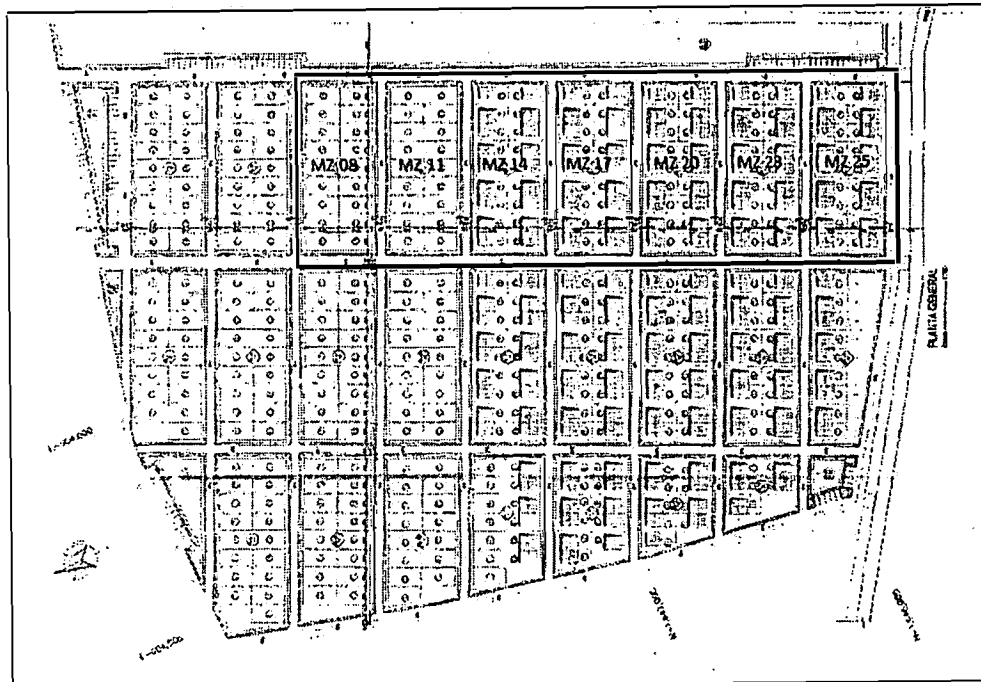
Planta general del proyecto y manzanas inspeccionadas.
